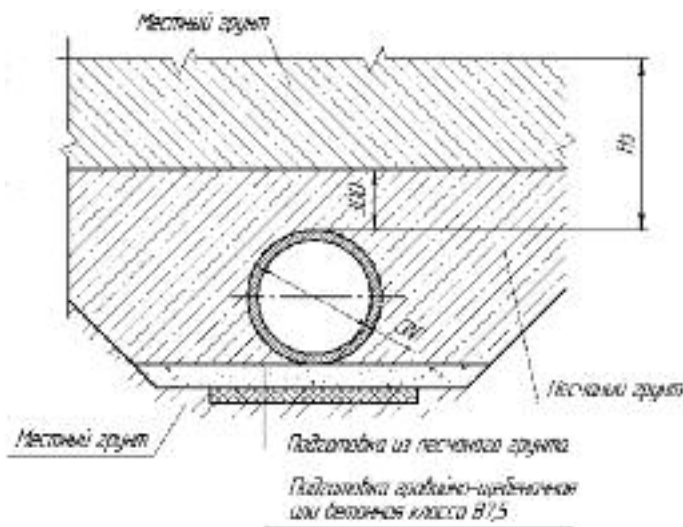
Укладка труб КОРСИС в водонасыщенных грунтах
